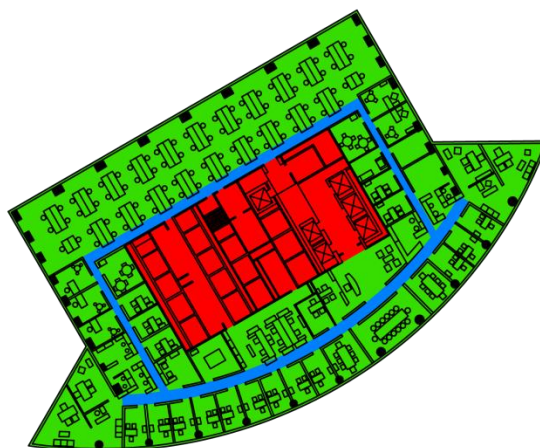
Análisis de Área Usable, Planta tipo Torre Mayor
